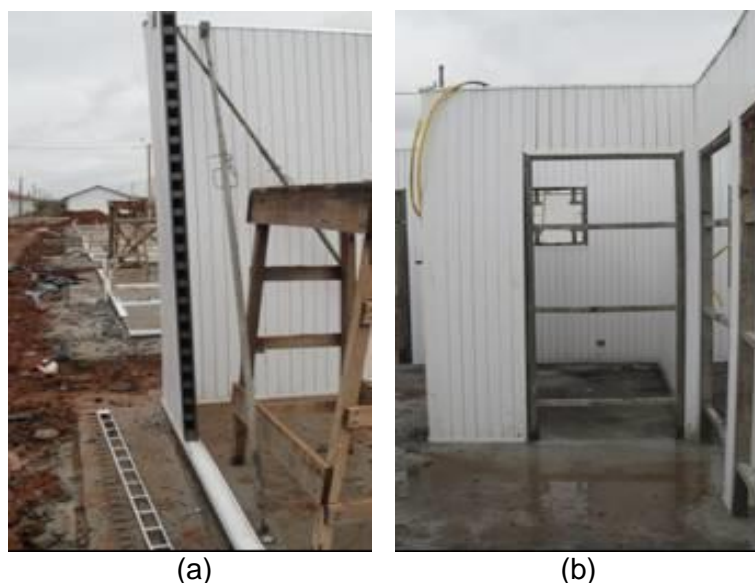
Preparação para lançar o concreto: (a) escoramento dos perfis; (b) gabaritos metálicos para conter o concreto.
